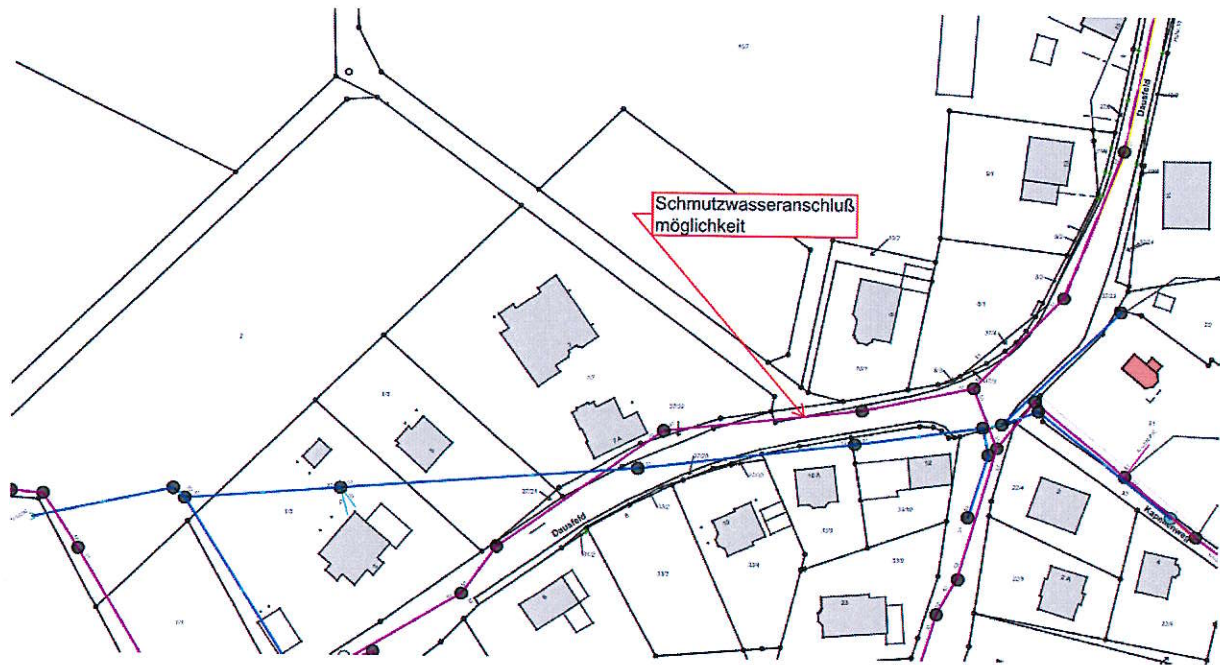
Lageplan Abwasserkanäle (o. Maßstab) Quelle: VG-Werke Prüm
